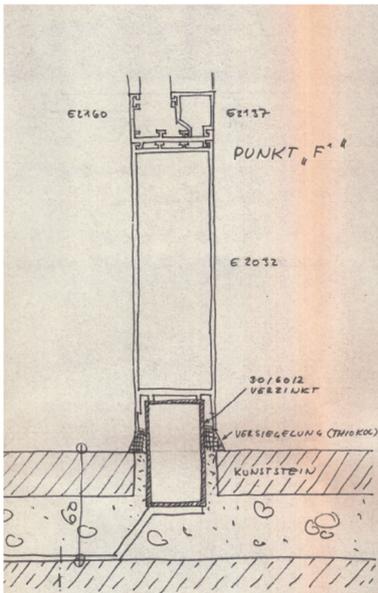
Planauszug, Detail Aluminiumfenster mit Dichtung „Thiokol“
